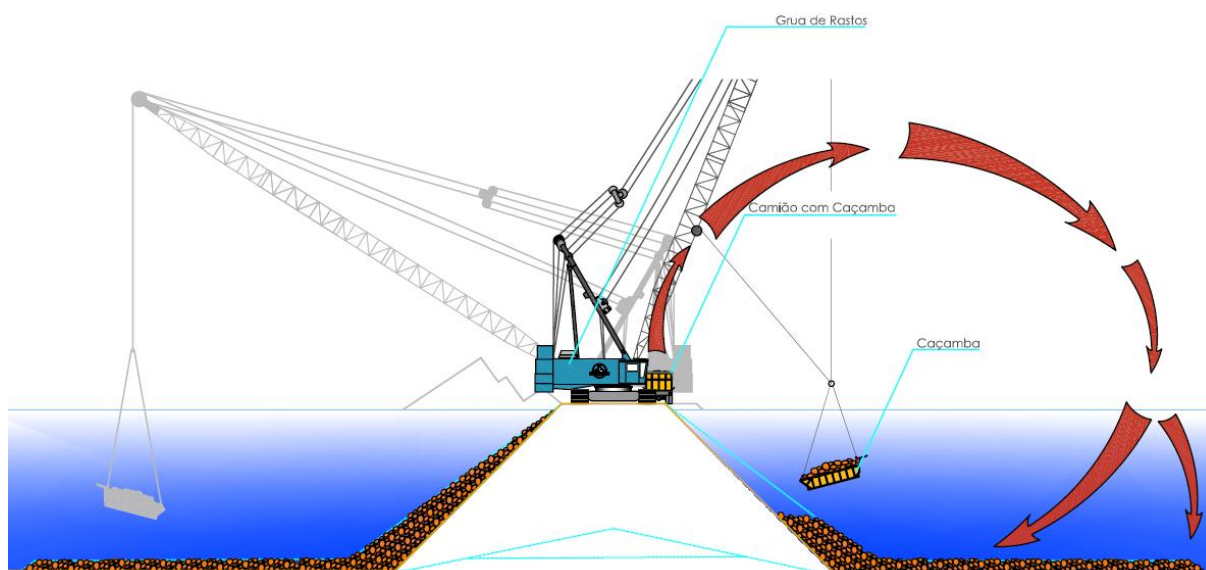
Construção da segunda subcamada, colocação de TOT e enrocamentos por meios terrestres, esquema em corte longitudinal 2. (ETERMAR – Engenharia e construção S.A.)
